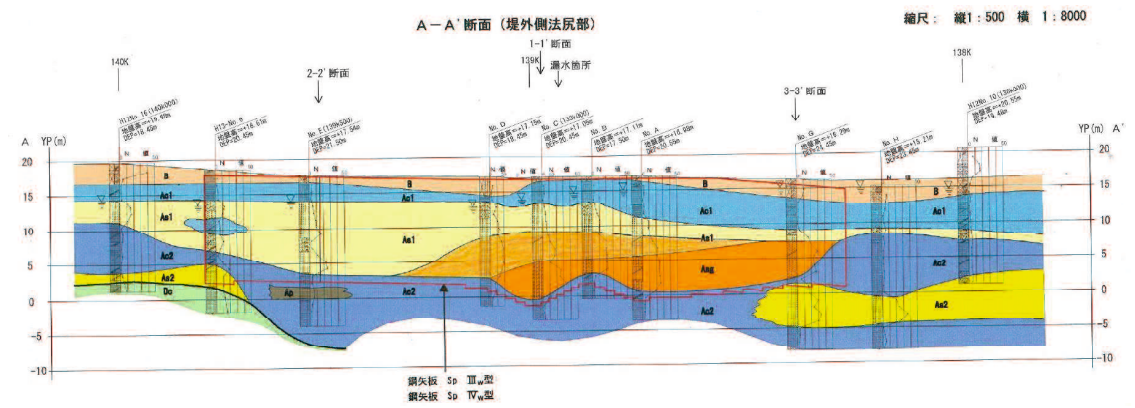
A-A'断面の基礎地盤土質縦断図
